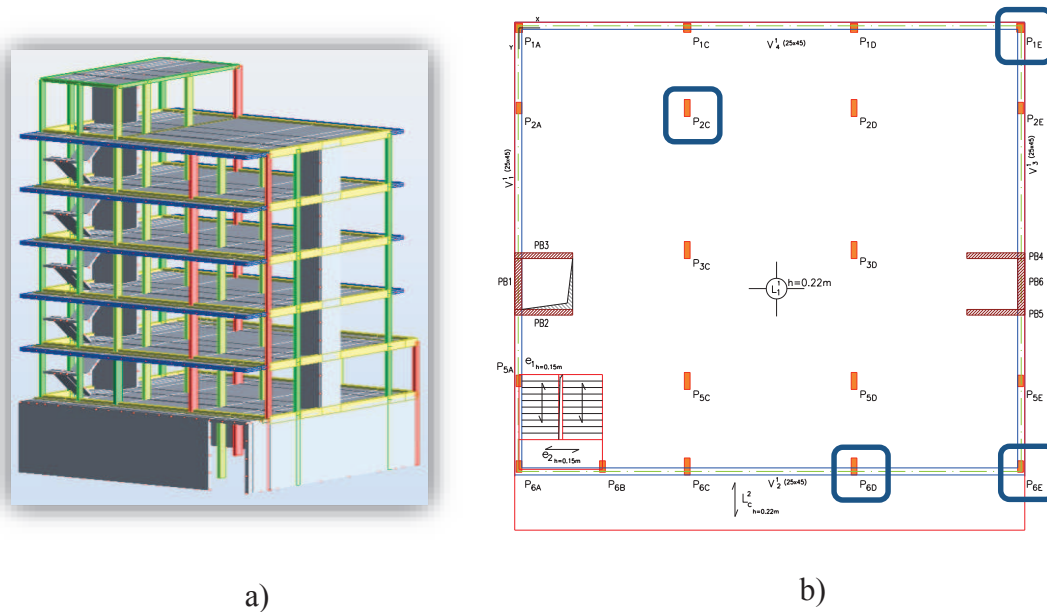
Pilares em análise: a) Modelação Estrutural e b) Localização dos pilares no piso 1
